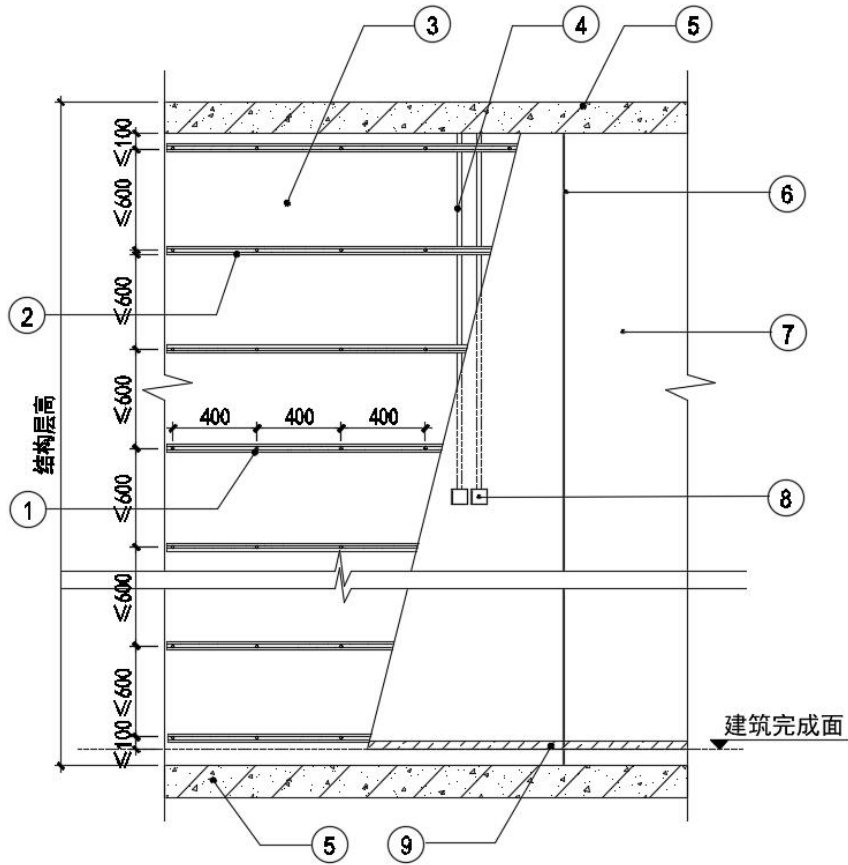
调平龙骨饰面板墙面系统构造示意图（立面图）
